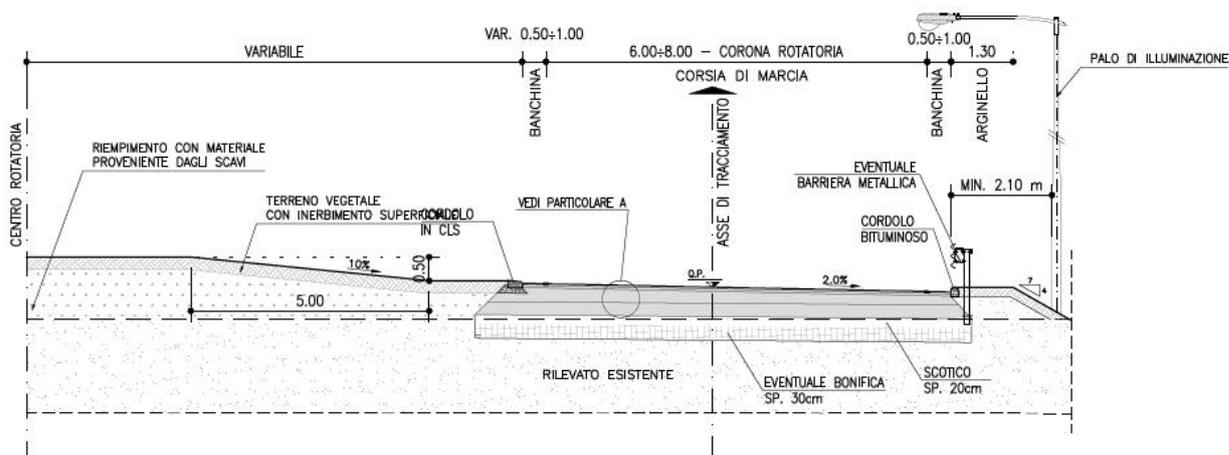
Sezione Tipo rotonda con corona insormontabile
